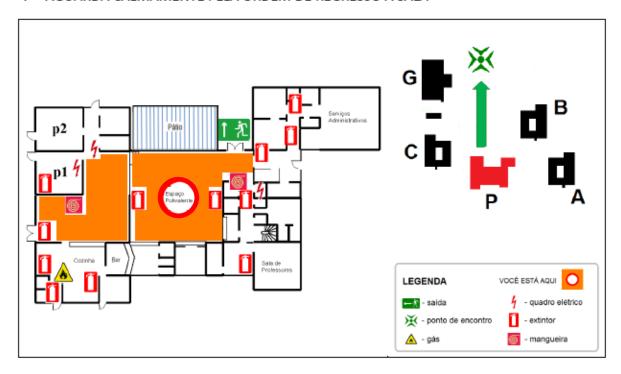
Planta e conjunto sintético de regras (afixado nas salas/espaços)
